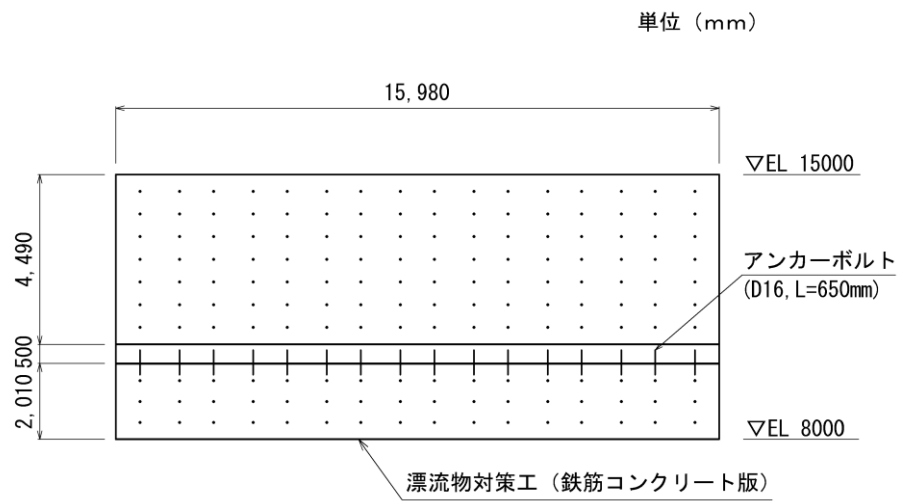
(1) 漂流物対策工（鉄筋コンクリート版）のアンカーボルト配置図（正面図）
